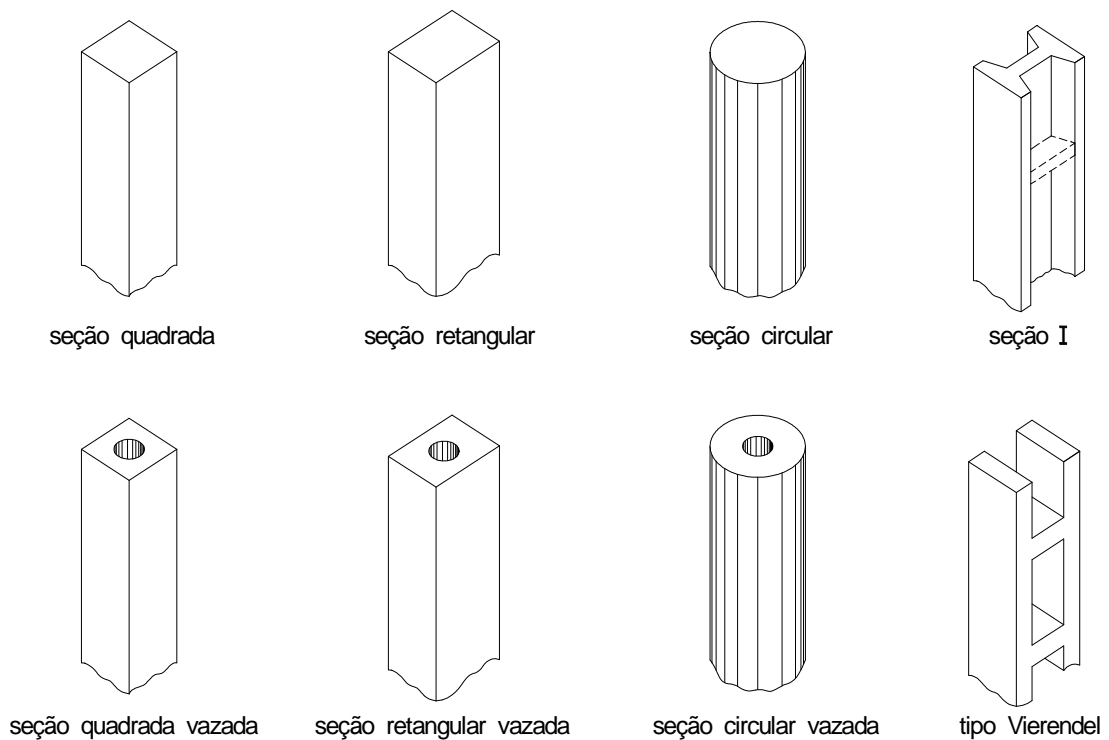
Seções transversais utilizadas em pilares pré-moldados
